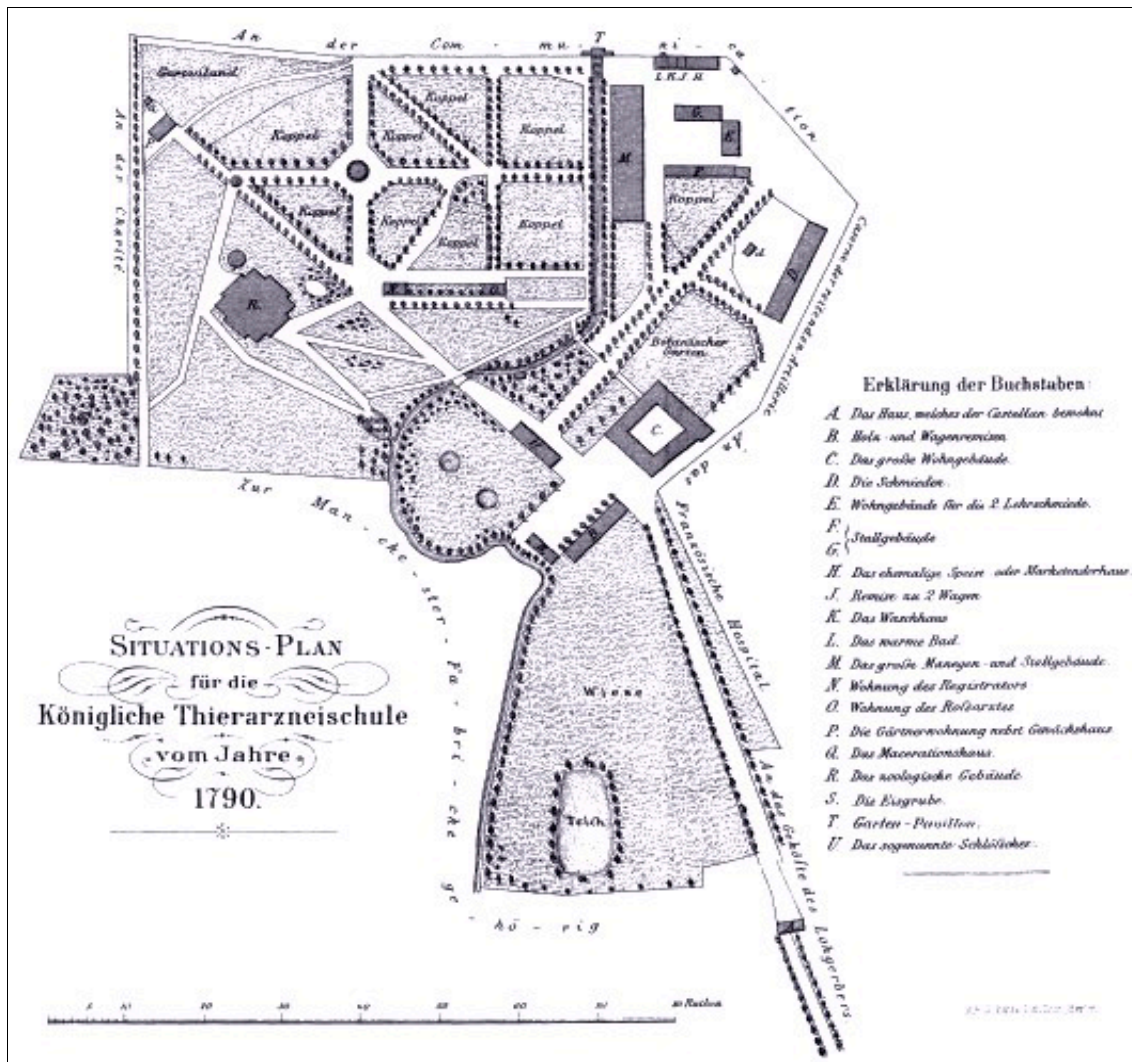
Grundriss der Tierarzneischule in Berlin 1790 (Schütz, 1890)
